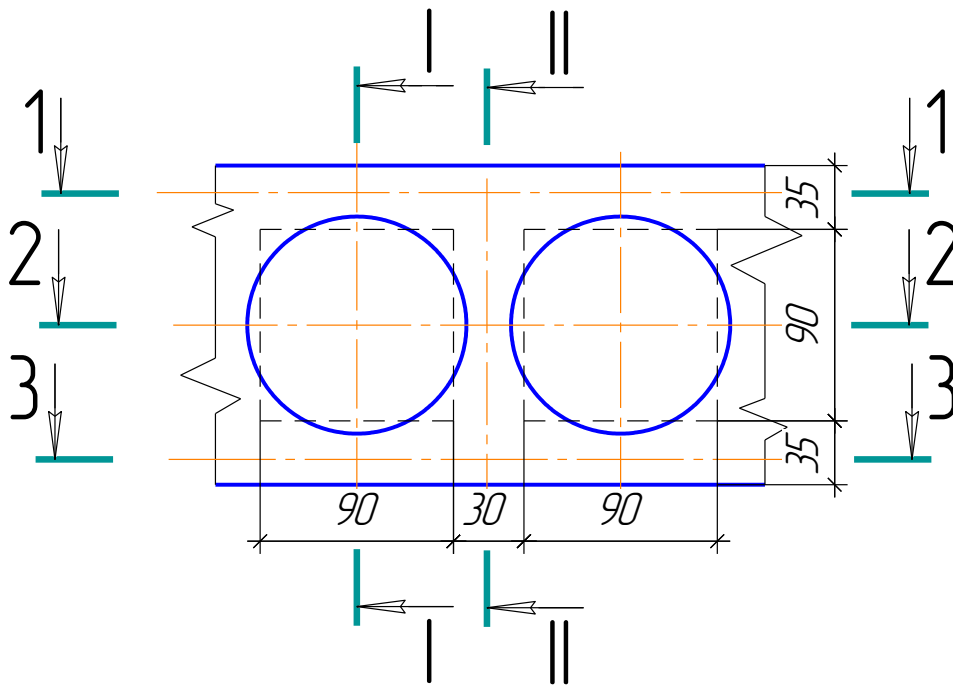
Схема розбивки плити перекриття на розрахункові області
